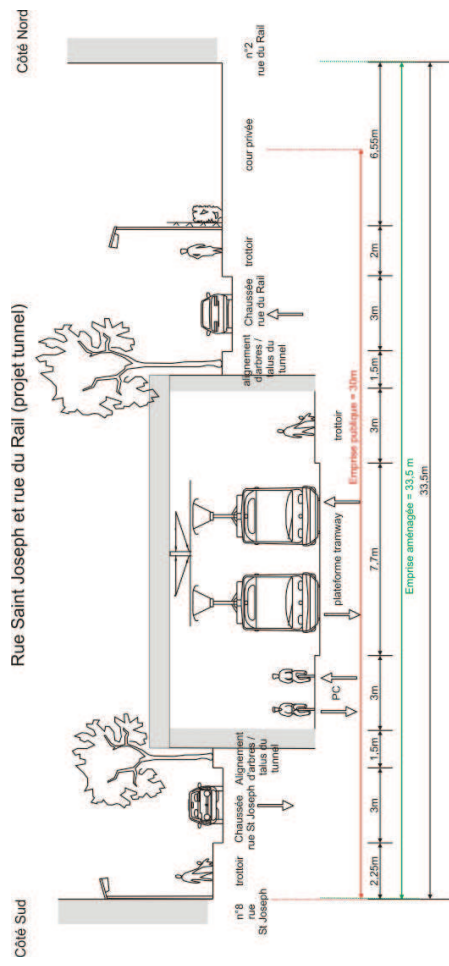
Aménagement projeté - coupe 7 (rue Saint Joseph - rue du Rail, option de franchissement "Tunnel")
